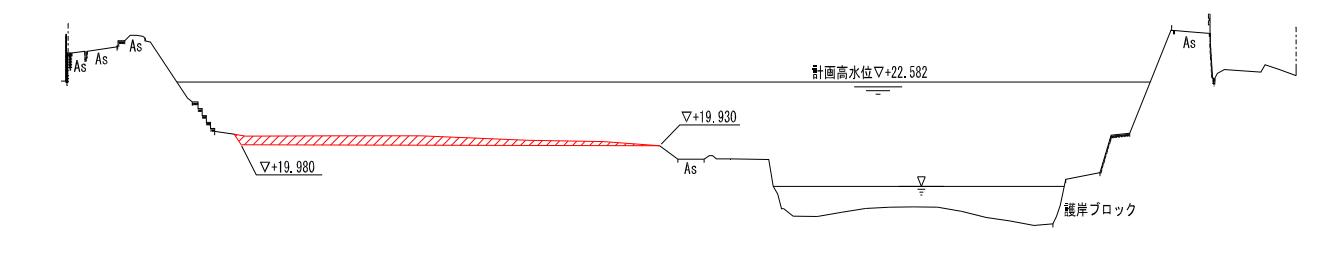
B-B断面図 (9.7k付近(No.60))
